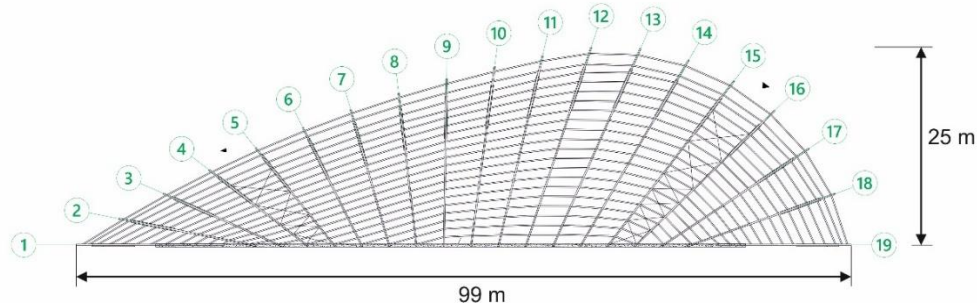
Planta de la estructura de cubierta (Oak Ingeniería)
